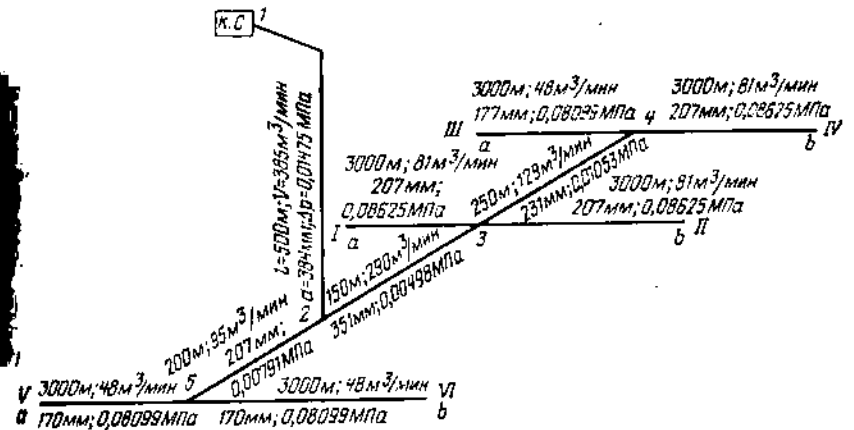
Схема воздухопроводной сети к примеру 2.11
